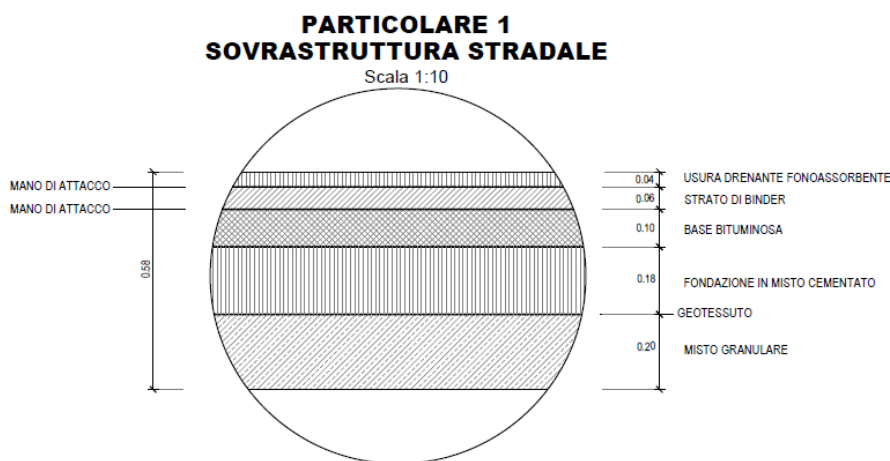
Pacchetto di pavimentazione stradale assunto nel progetto esecutivo
